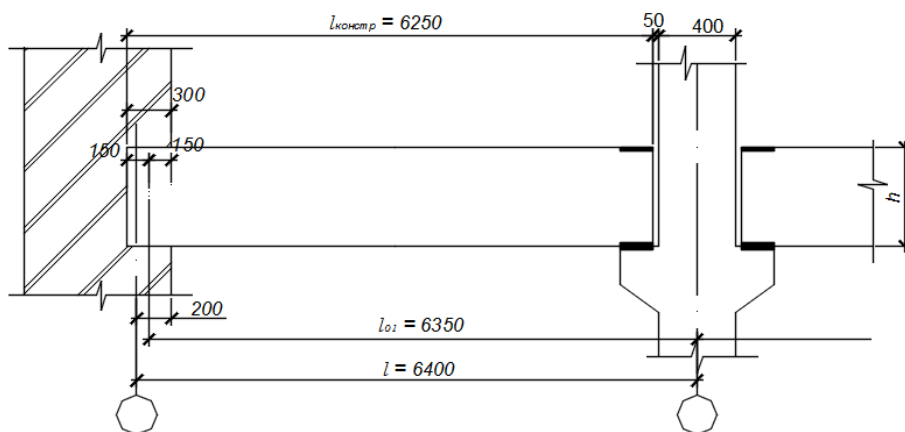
До визначення розрахункового прогону ригеля промислової будівлі
